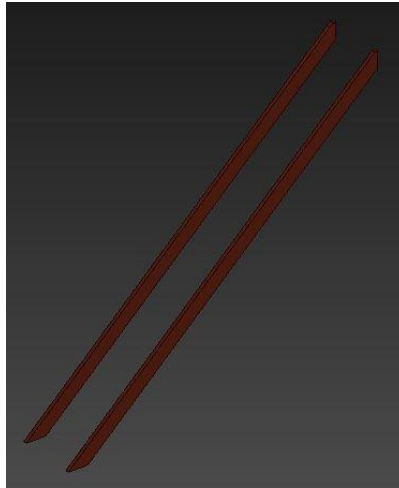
Vista de las vigas de soporte que sostienen la escalera.
